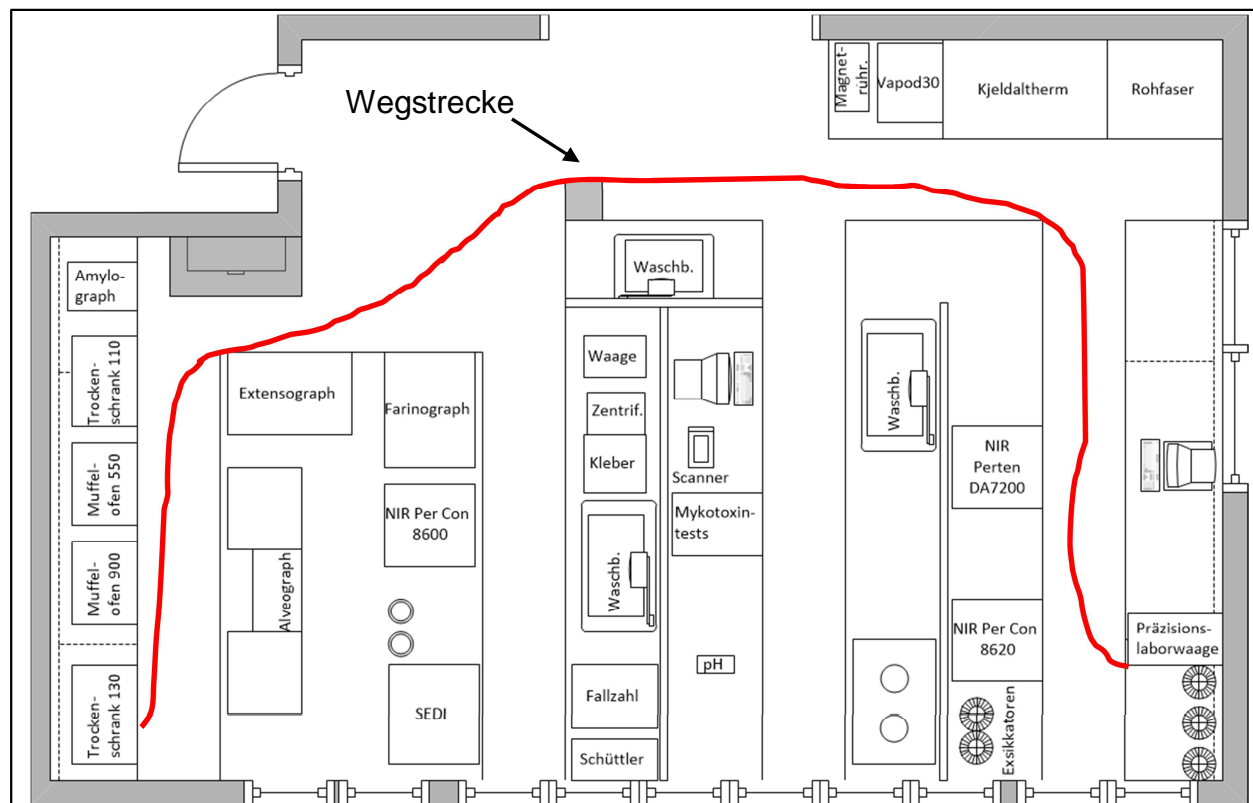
Grundriss Labor mit Wegstrecke
